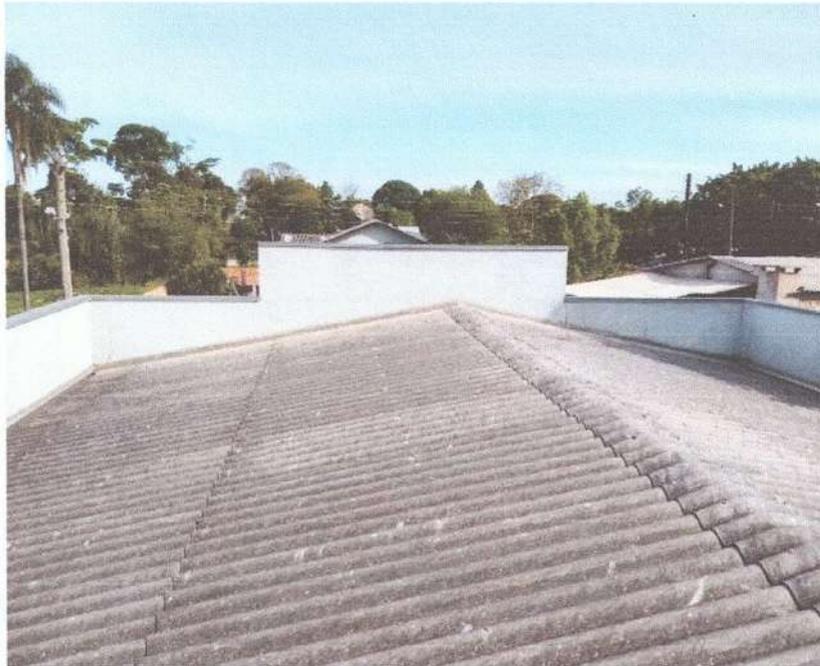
Laje fachada impermeabilizar, regularizar contrapiso da laje e inclinação.
